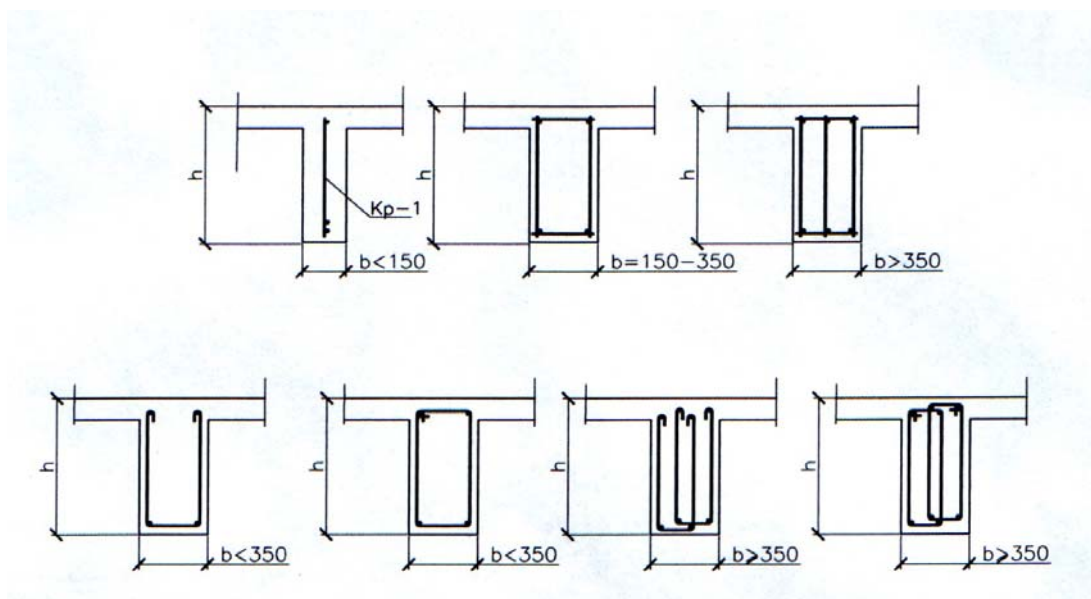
Схемы армирования балок сварной и вязаной арматурой
